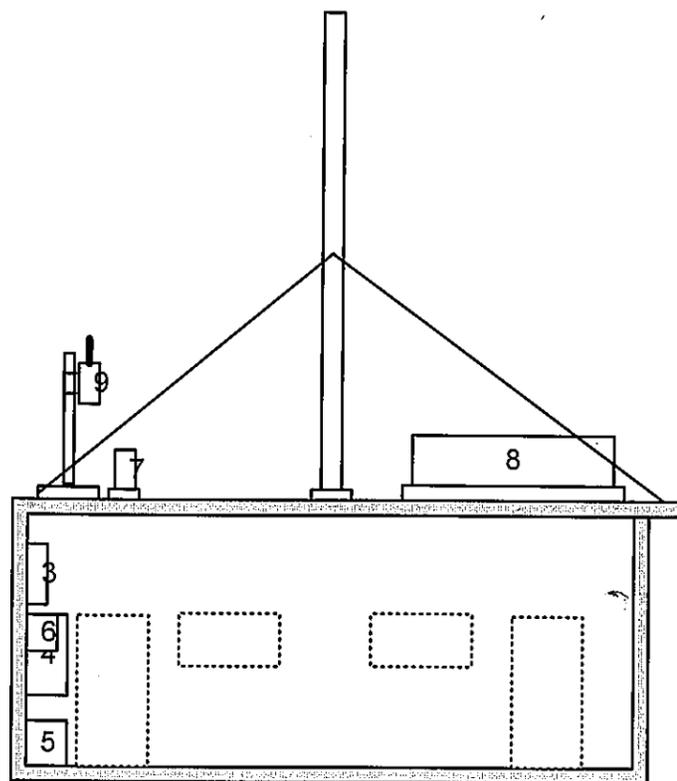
PLAN D'AMENAGEMENT DES EQUIPEMENTS
